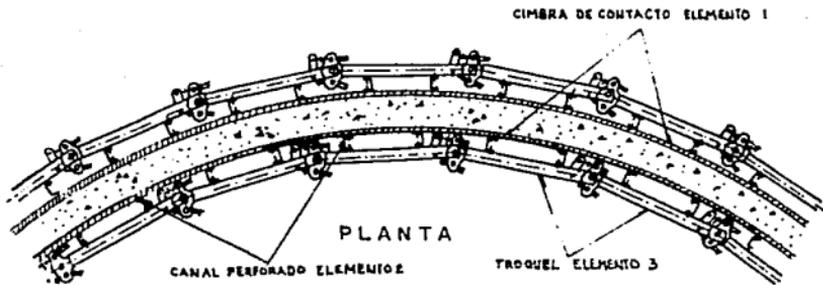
Instalación total Cimbra Trepante - PLANTA -
